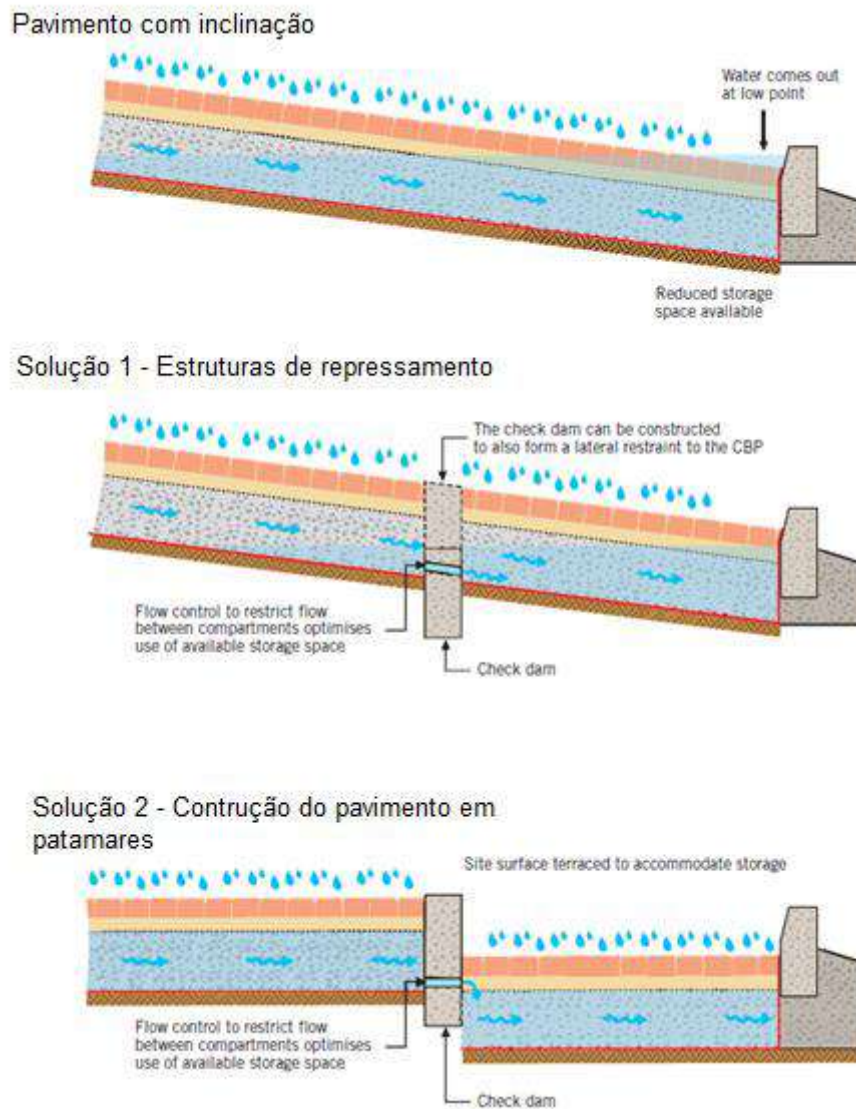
Soluções para pavimentos permeáveis com inclinação (INTERPAVE, 2010)
